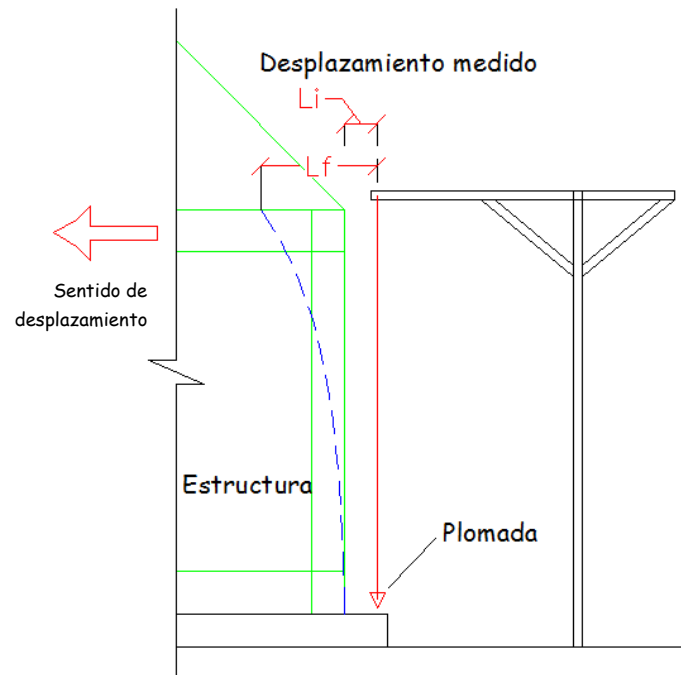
Esquema de sistema de medición de desplazamiento con plomadas en pórtico 4. Fuente: Autor.
